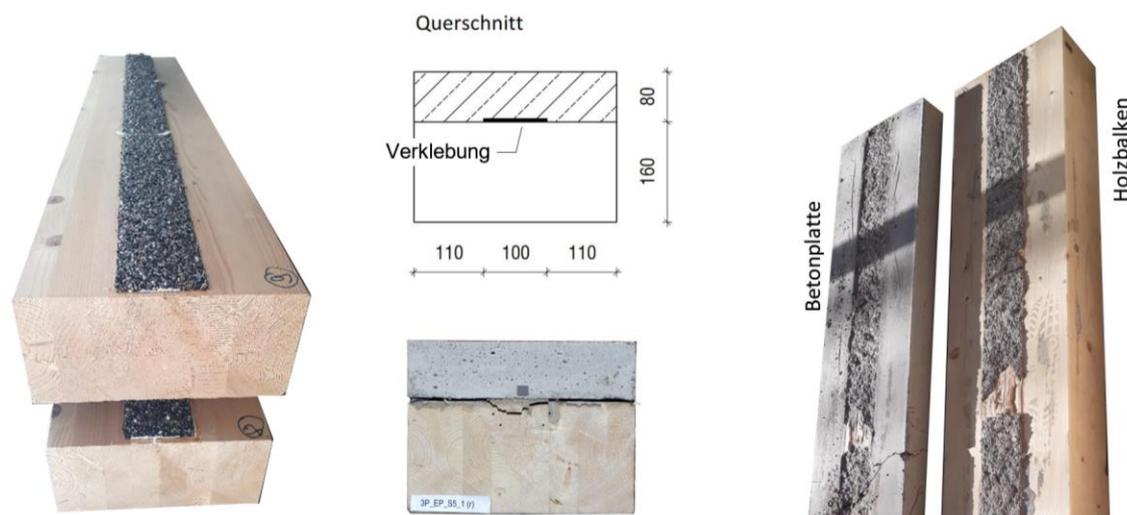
Kurze Biegeträger mit schmaler Fuge: Links: Vor dem Betonieren. Rechts: Nach den Versuchen mit Beton- und Holzversagen. Das Bild zeigt vorwiegend Betonversagen
